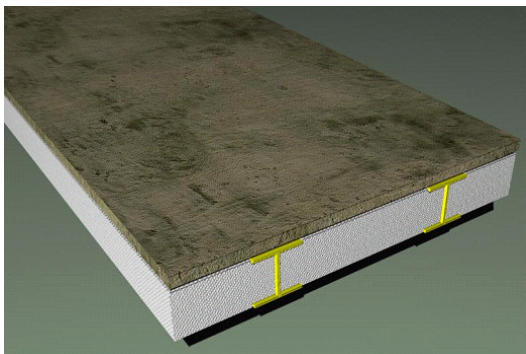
Laje Mista de Concreto/PRFV (SANTOS NETO, 2006).
